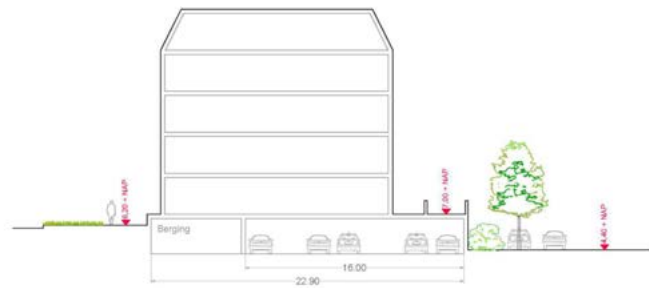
Schetsplan Bloemenkampkwartier, West 8
